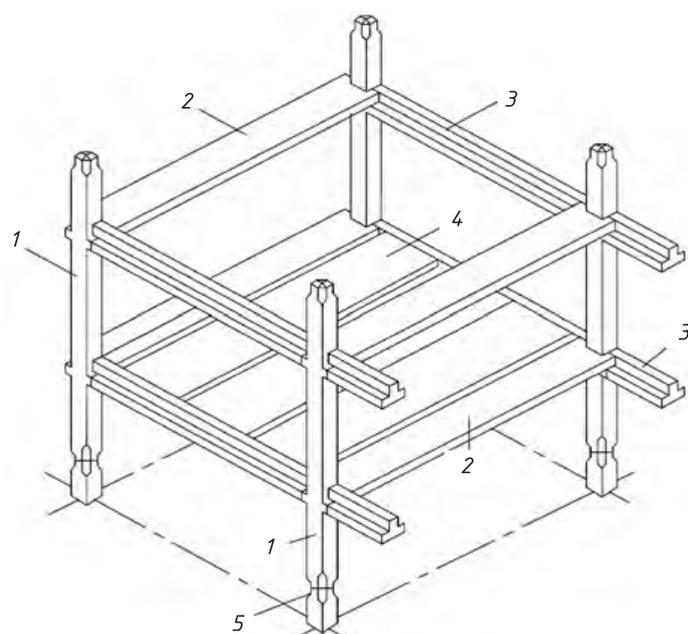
Сборный железобетонный унифицированный каркас: 1 — колонны сечением 400×400 мм; 2 — настил-распорка; 3 — ригель таврового сечения; 4 — настил перекрытия; 5 — стык колонн
